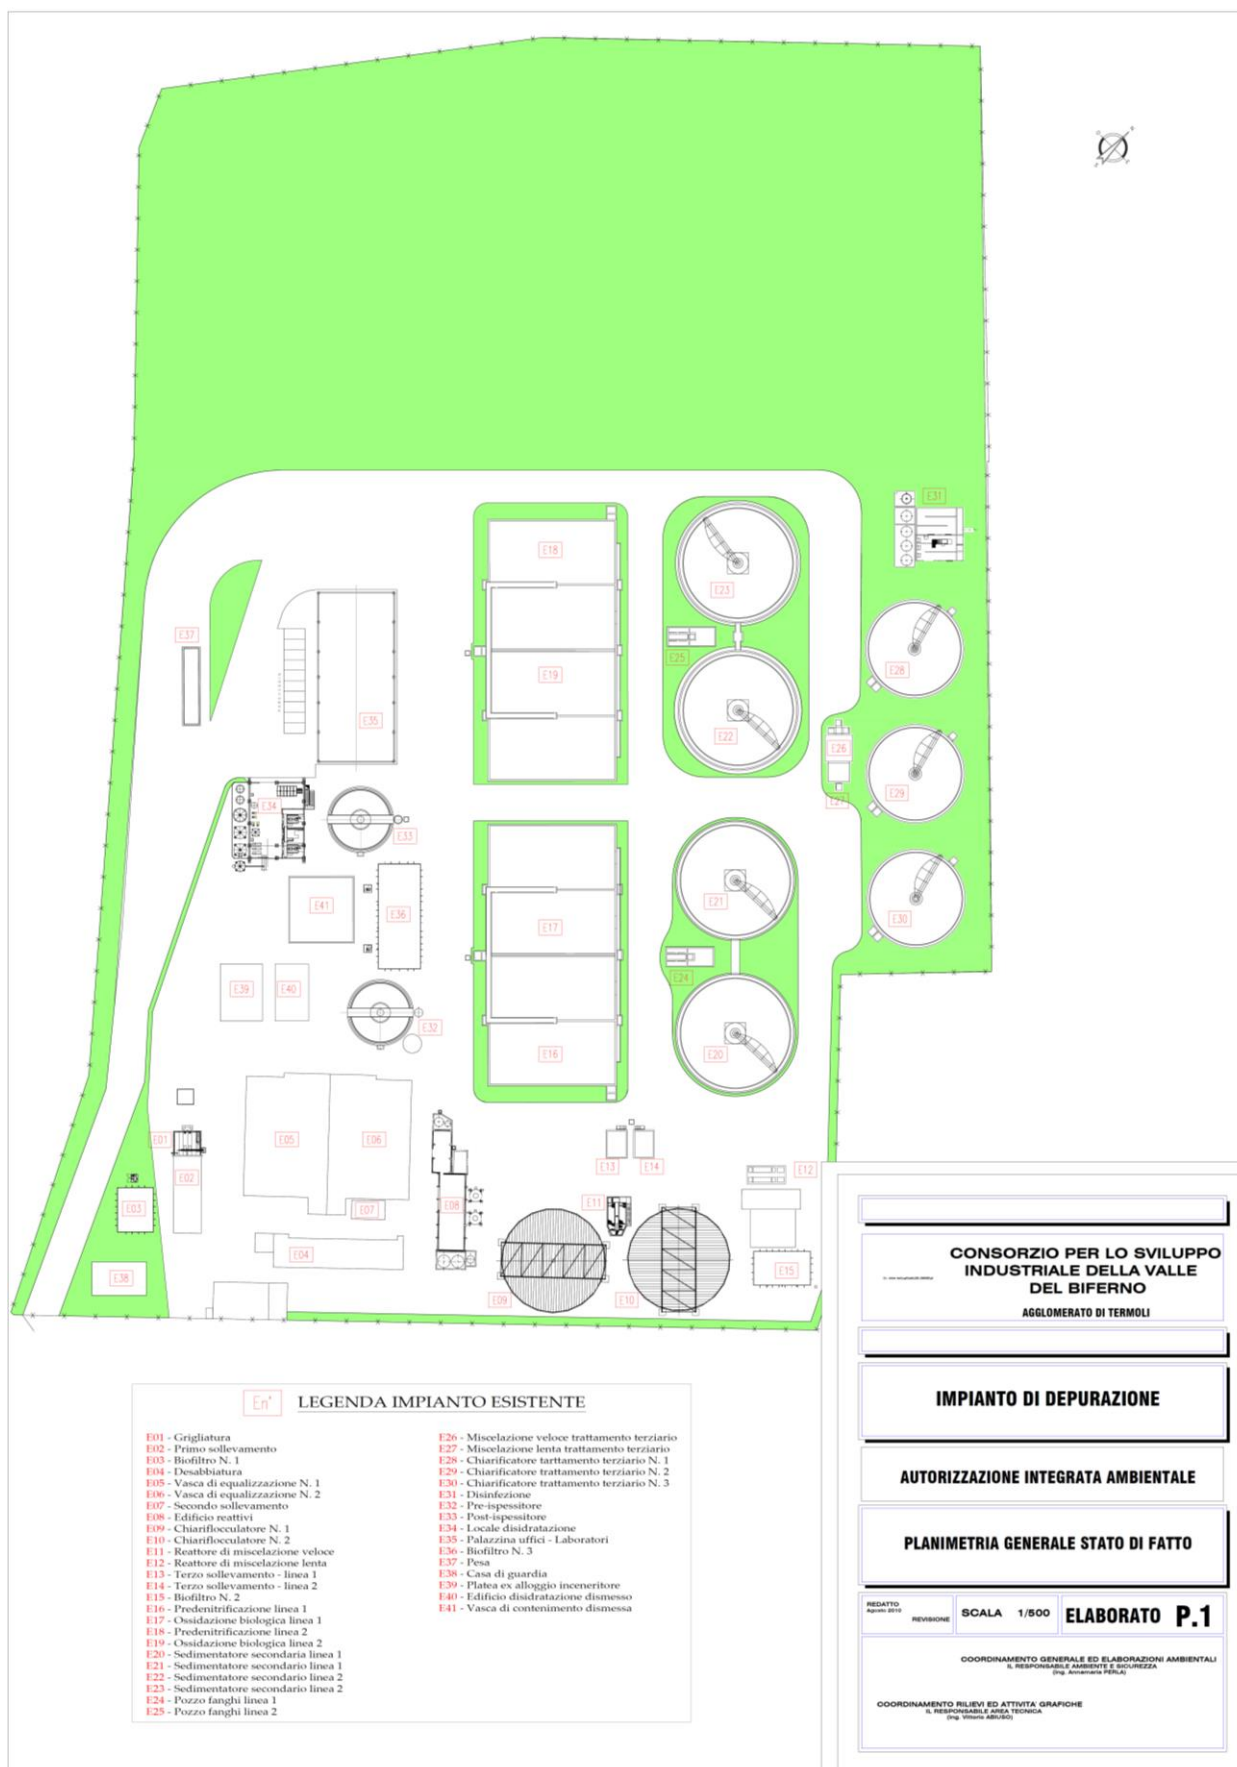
planimetria generale dell'impianto: stato di fatto anno 2010
